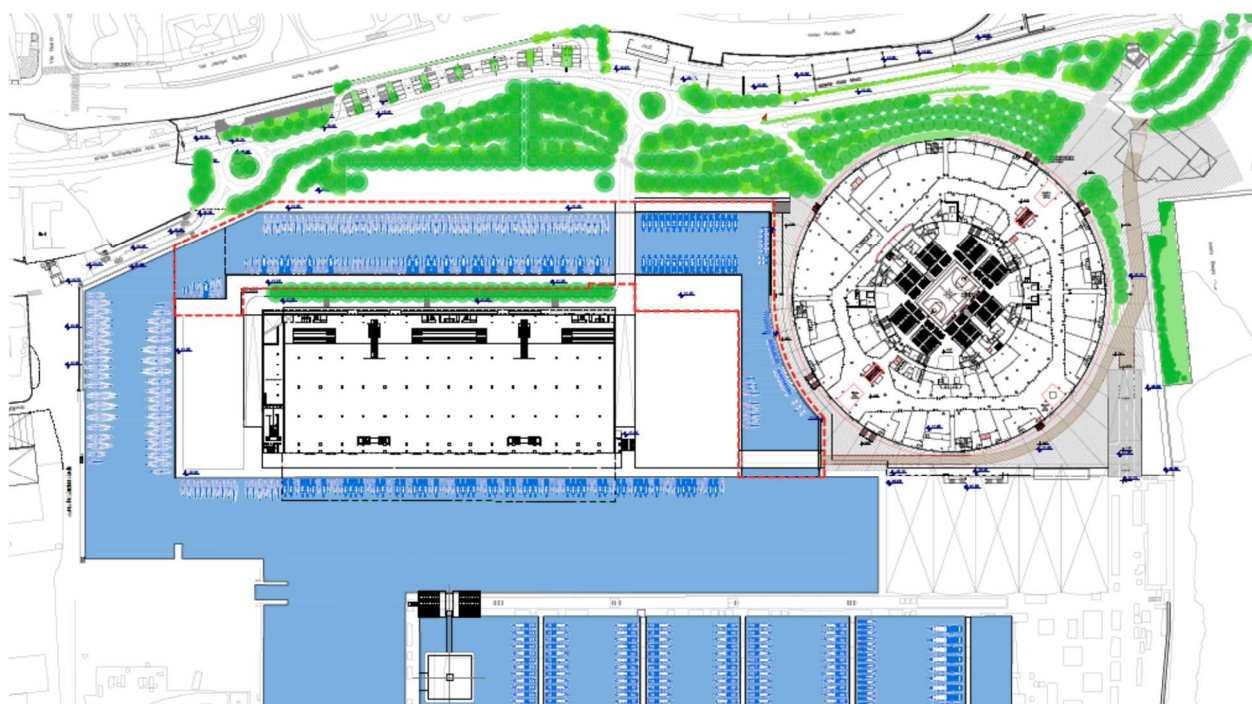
Planimetria generale di progetto a quota +5,50 – Stralcio elaborato Ar-T04
